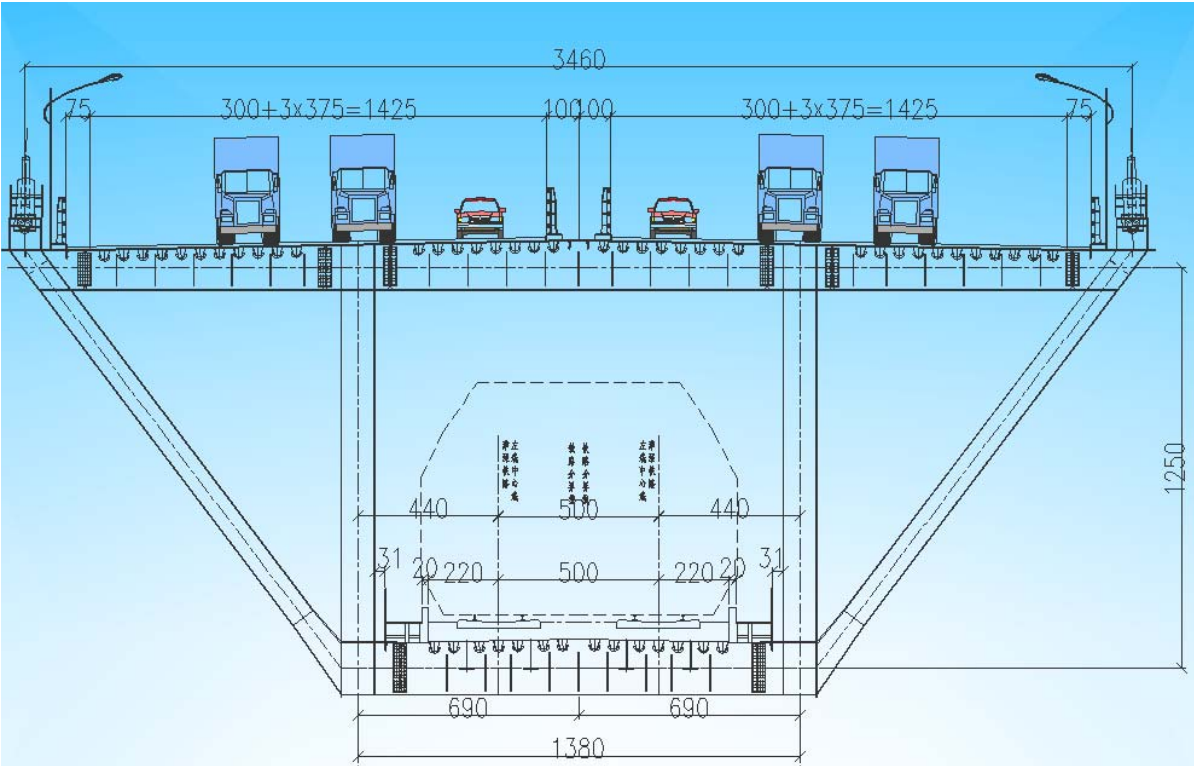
公铁分层主桥横断面布置图 (单位: cm)
